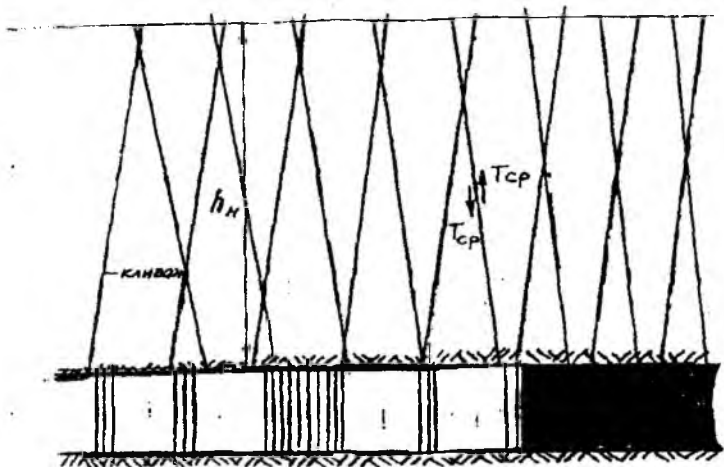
Схема деформирования пород кровли (в районе скважины №1) на 110м, при разрушении от скола.
